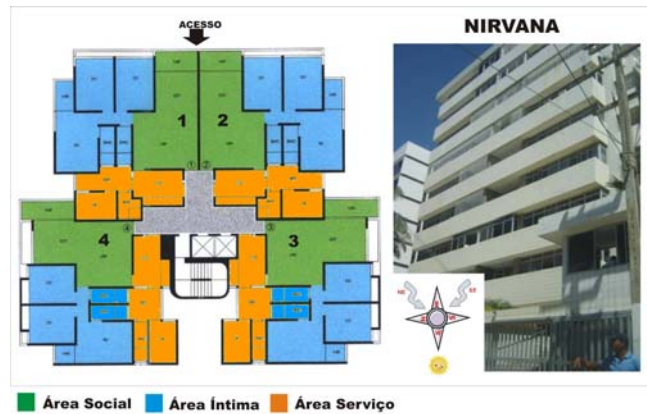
Planta do pavimento tipo do Edifício Nirvana, foto da fachada Leste, e esquema da direção dos ventos
